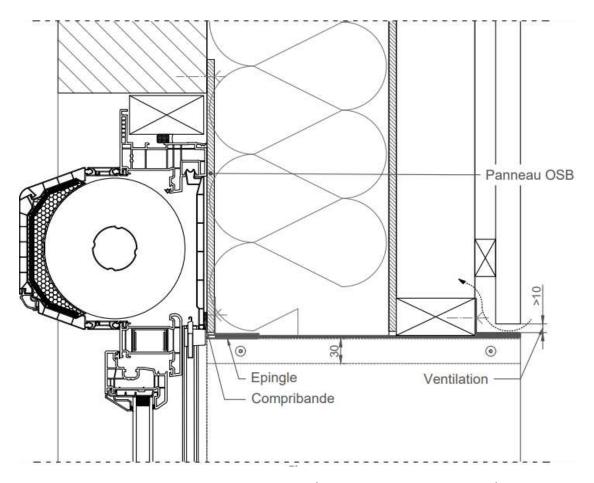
Vue en coupe – Ventilation par ossature secondaire
